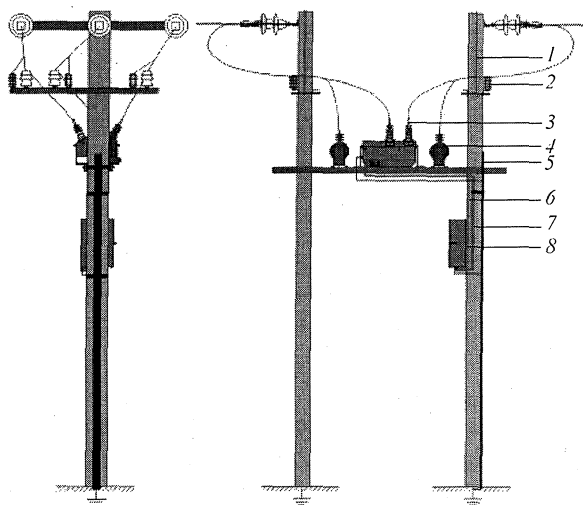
Установка реклоузера РВА/TEL на опоры: 1 — заземление ОПН; 2 — ограничитель перенапряжений; 3 — коммутационный модуль; 4 — трансформаторы тока; 5 — шина заземления; 6 — цепи питания; 7 — соединительный кабель; 8 — шкаф управления
